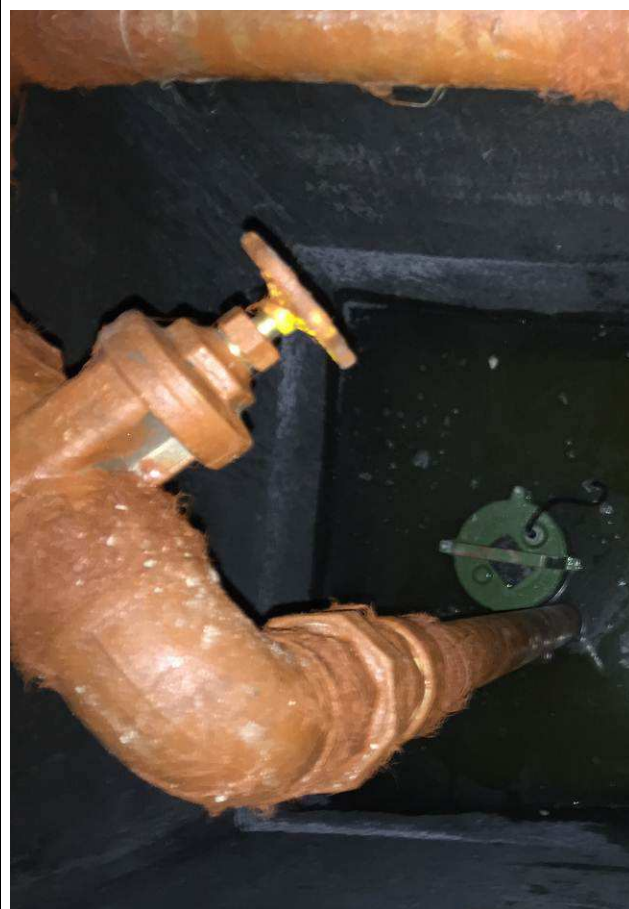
C: Detalhe da tubulação e registro de gaveta 2" em primeiro plano.
